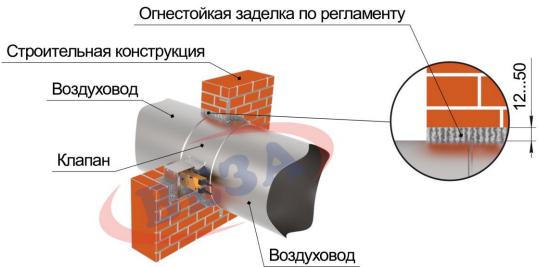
Монтаж клапана стенового типа круглого сечения
